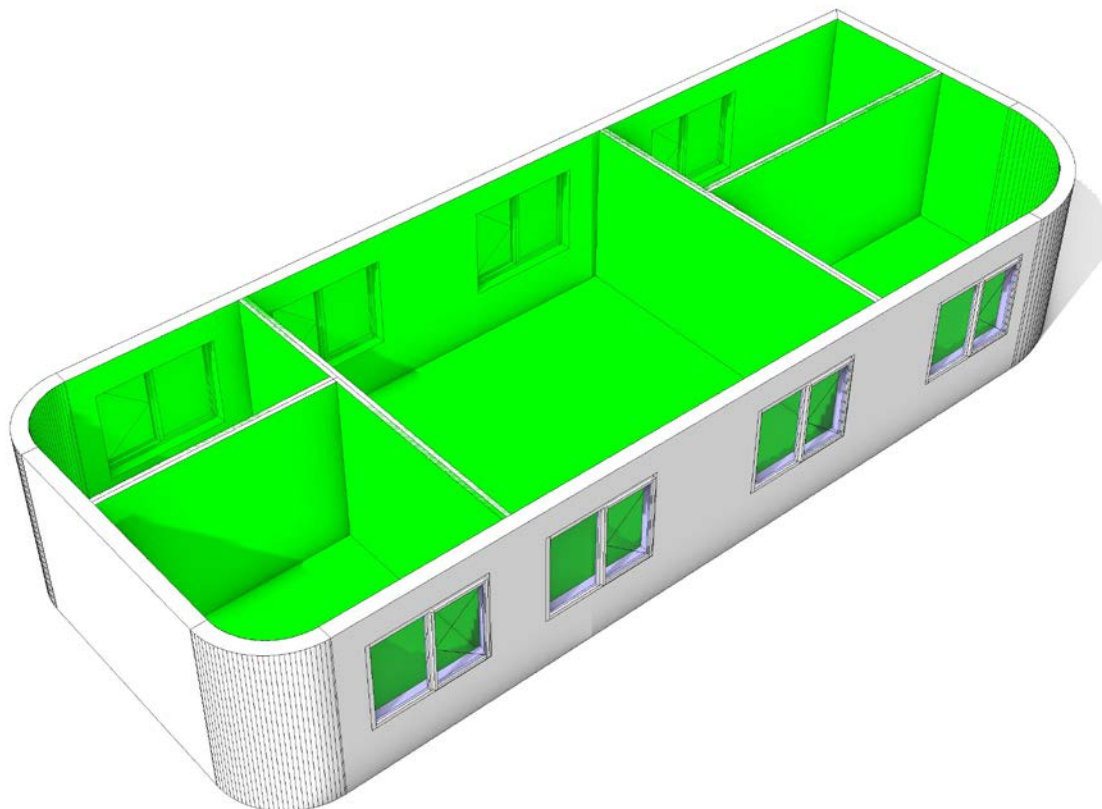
Пространства (помещения) вместе со строительными элементами (стены и окна) в ЭМ
